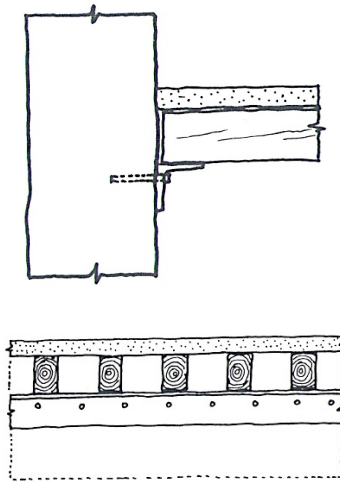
Apoio das extremidades das vigas. Solução com perfil metálico. Arriaga [1]
